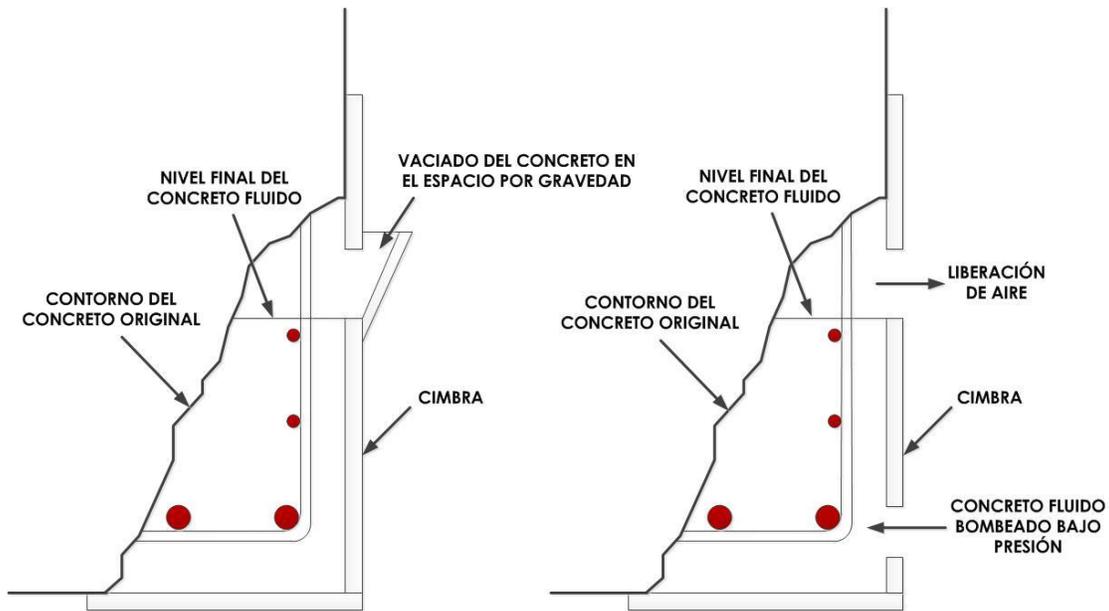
Ejemplo de aplicaciones en fluido en una viga de concreto (Ryall, 2001)
